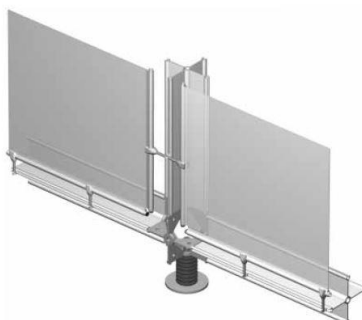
Exemplo ilustrativo de uma possível configuração construtiva do sistema PILA utilizando alguns acessórios que podem ser acoplados ao perfil
